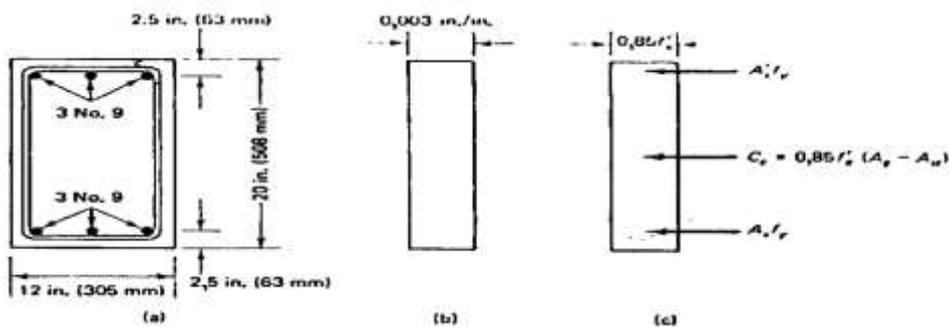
Hubungan tegangan regangan pada beton dan baja (beban sentris)
